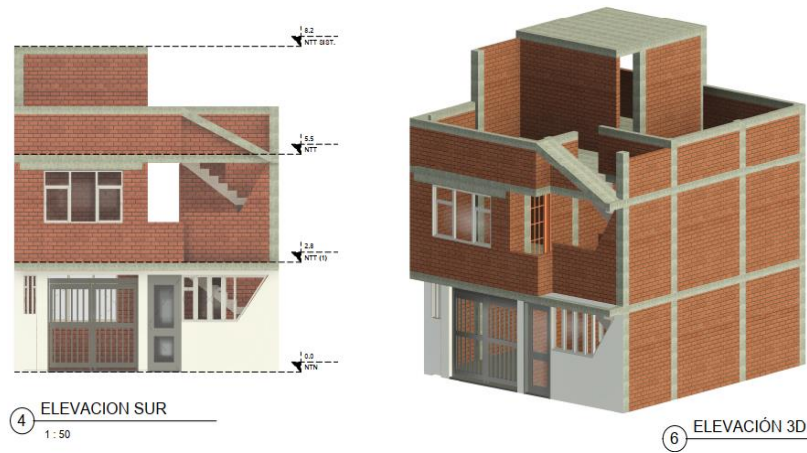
Corte longitudinal y vista 3D de la vivienda C-14
